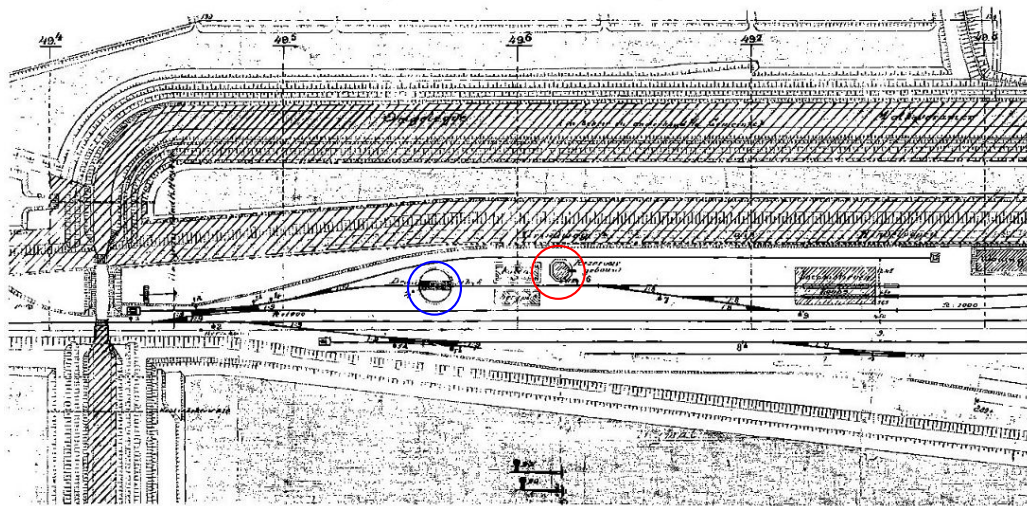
Voorbeeld van de draaischijf uit Amsterdam CS van jaar 1881.
